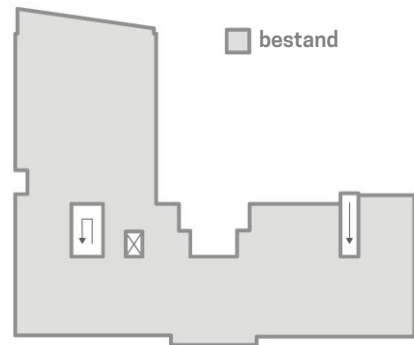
Schema Bestand: Grundriss Kellergeschoß.
